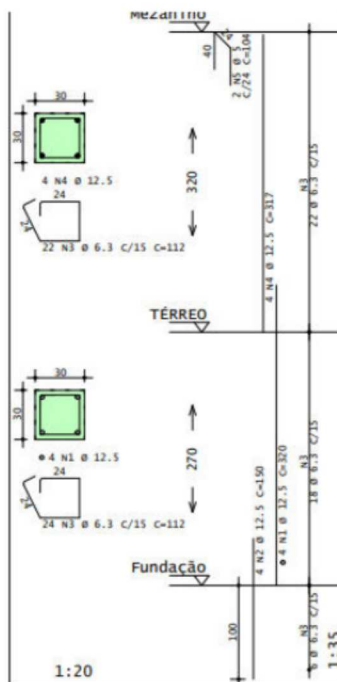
Armação dos pilares no projeto calculado (P6, P7, P10, P11).
